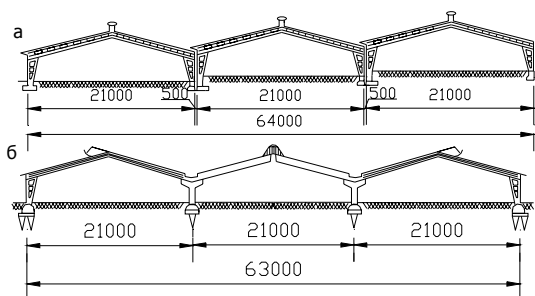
Блокированные и многопролётные здания с каркасом из сборных железобетонных рам:
